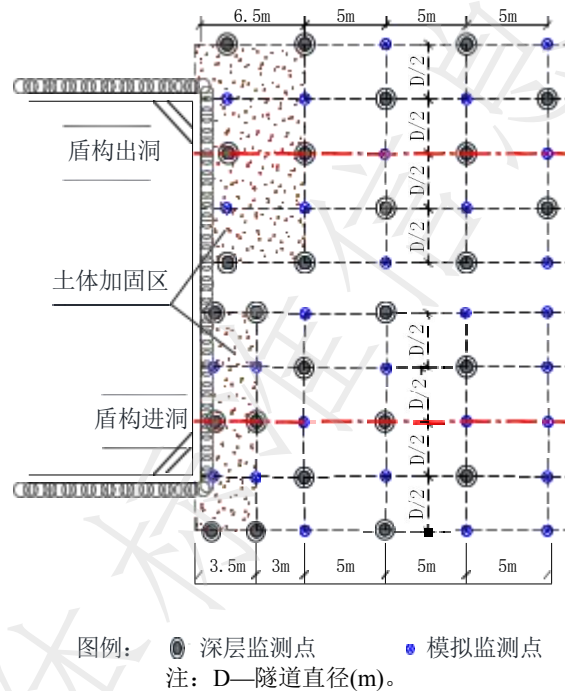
盾构进出洞施工地面环境监测沉降点布置平面图
